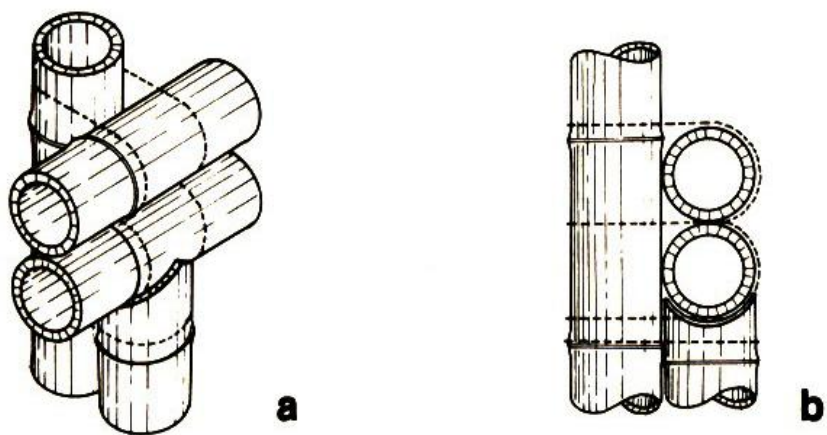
Viga dupla lateral. Cada uma das vigas se amarra independentemente do suporte lateral e entre si. Tem uma grande diversidade de aplicações em estruturas de pontes e instalações rurais.
